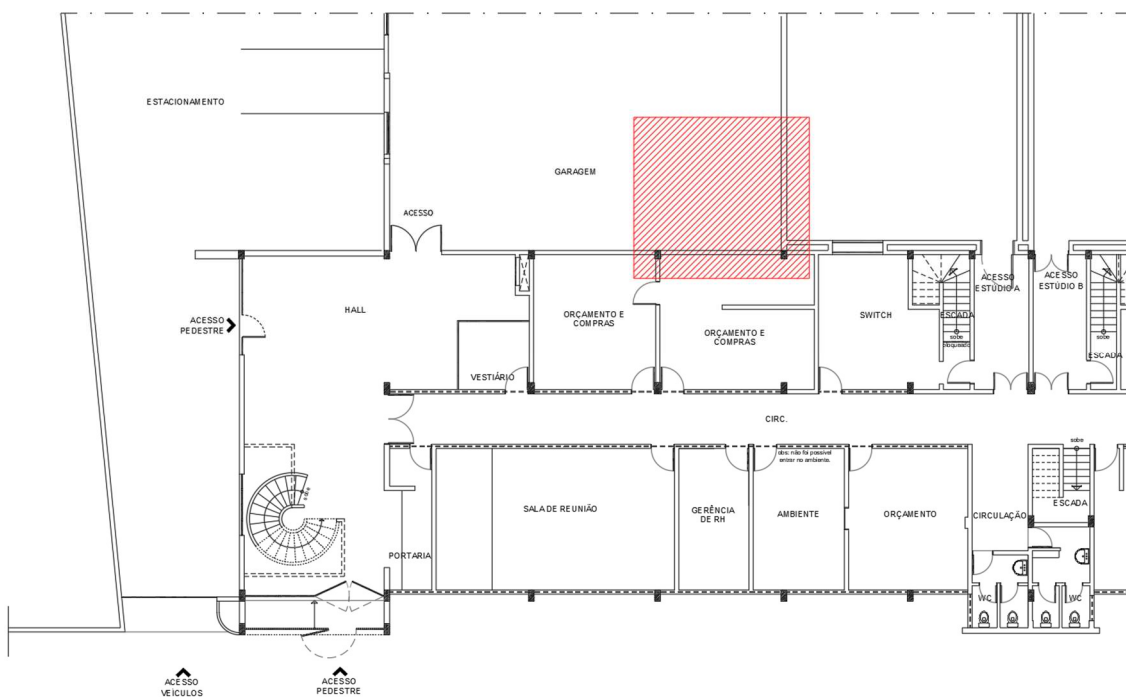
Trecho da planta baixa do pavimento térreo demarcando onde será construída a caixa corrida do elevador.
